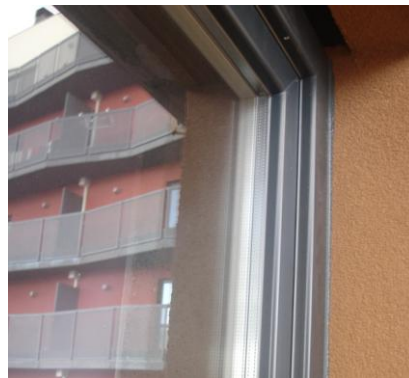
Pormenor construtivo dos envidraçados com protecção exterior, Guarda
